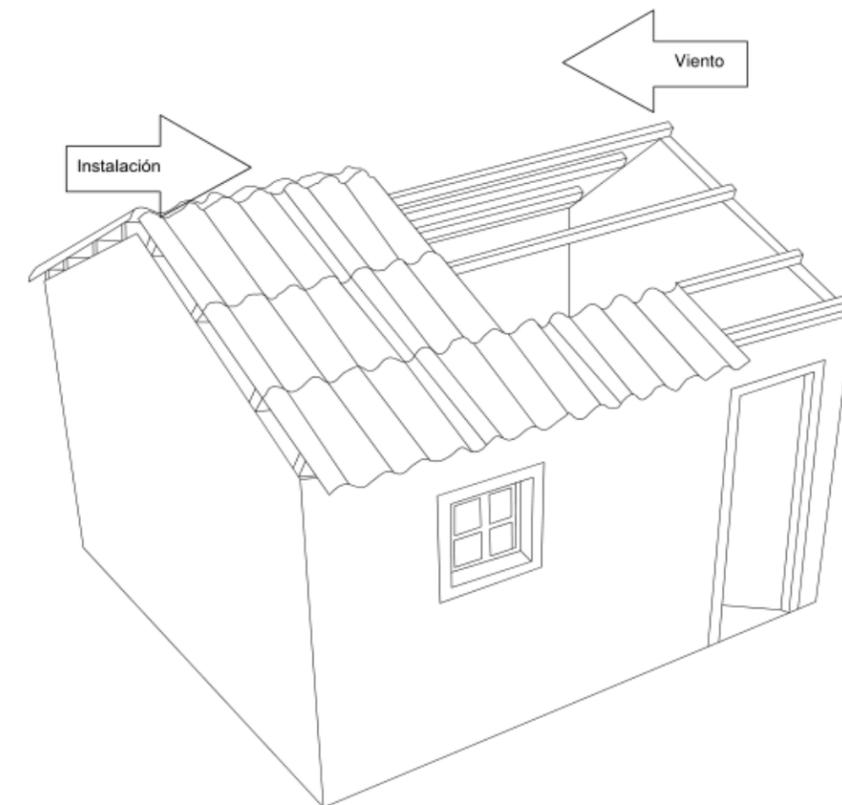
Instalación de cubierta de techo. Fuente: equipo de trabajo
